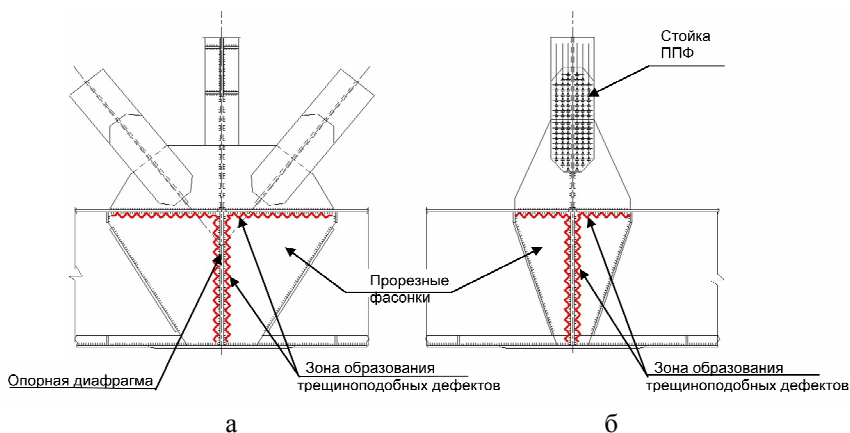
Схема мест расположения дефектов в узле сопряжения прорезных фасонек со стенкой и верхним поясом коробчатого нижнего пояса ППФ:
